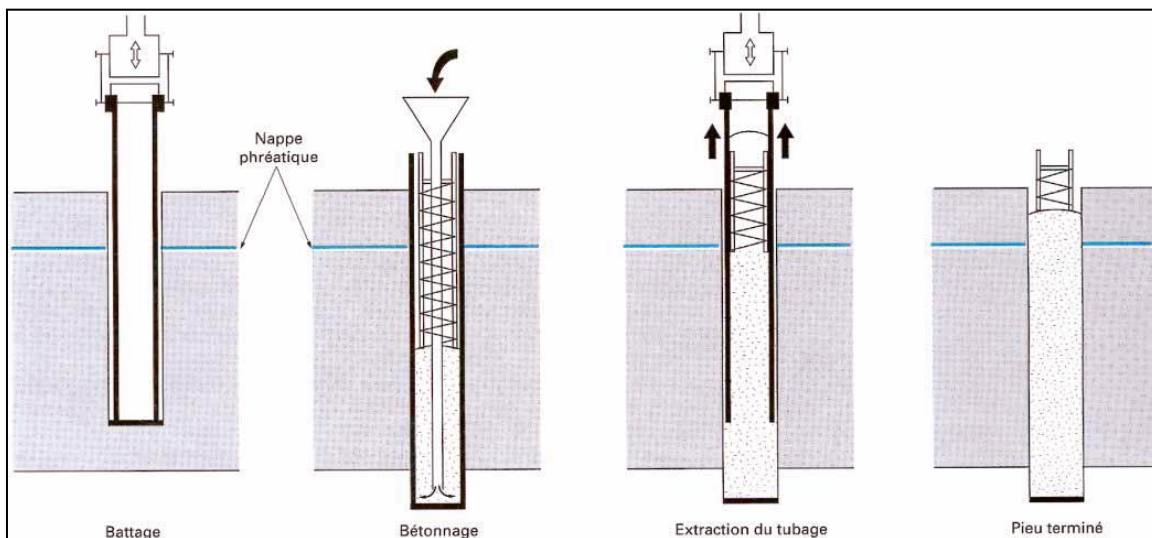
Pieu battu moulé (d'après doc. Études et travaux de fondation)
